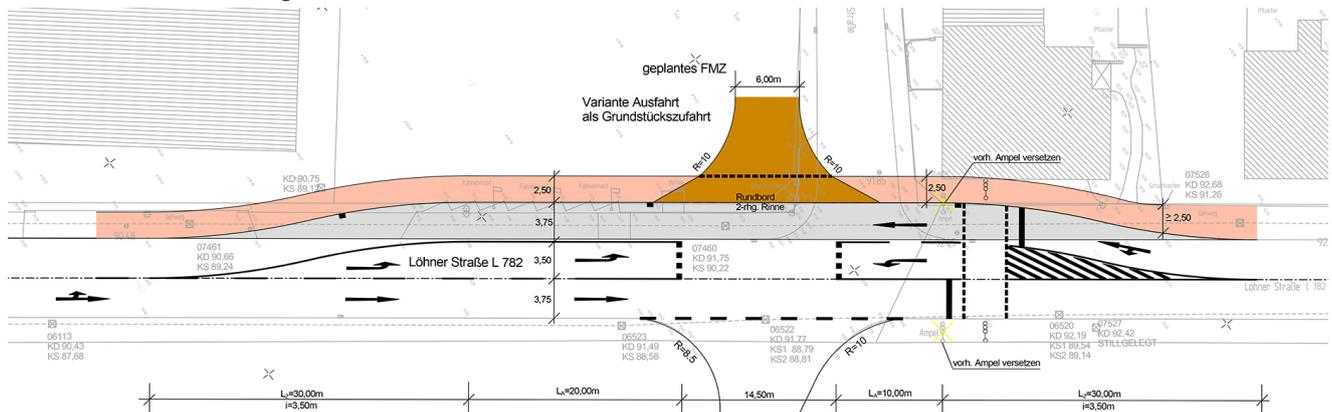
Knotenpunkt Löhner Straße in Eilshausen - Variante C-1
